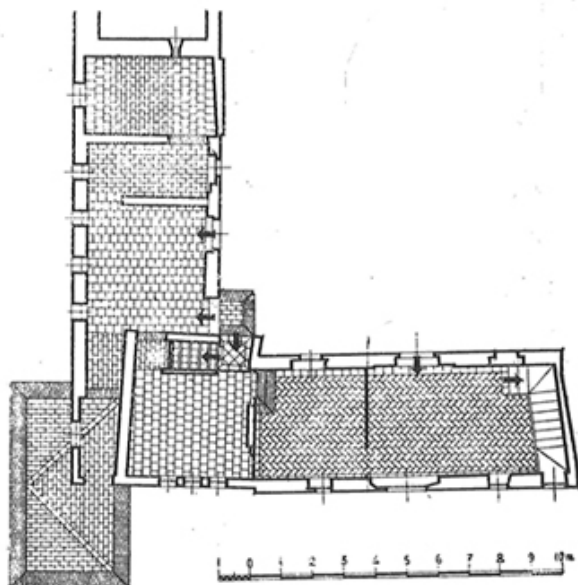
Croquis, Las flechas indican el punto de vista del plano 1.2.10 en vertical y de la foto 1.2.11 en horizontal. (Anónimo).
